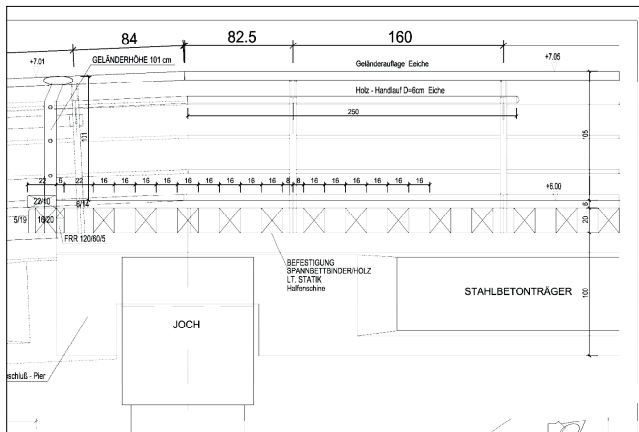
Plandetail mit Lage der Tragbalken 16x20 cm, Abstand 16 cm
